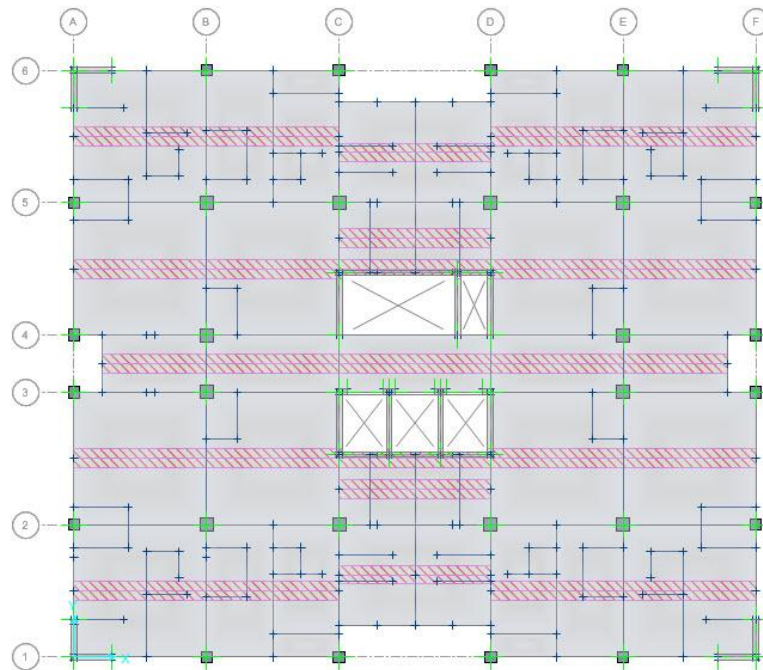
Mặt bằng ô sàn tầng điển hình (Tầng 10)
